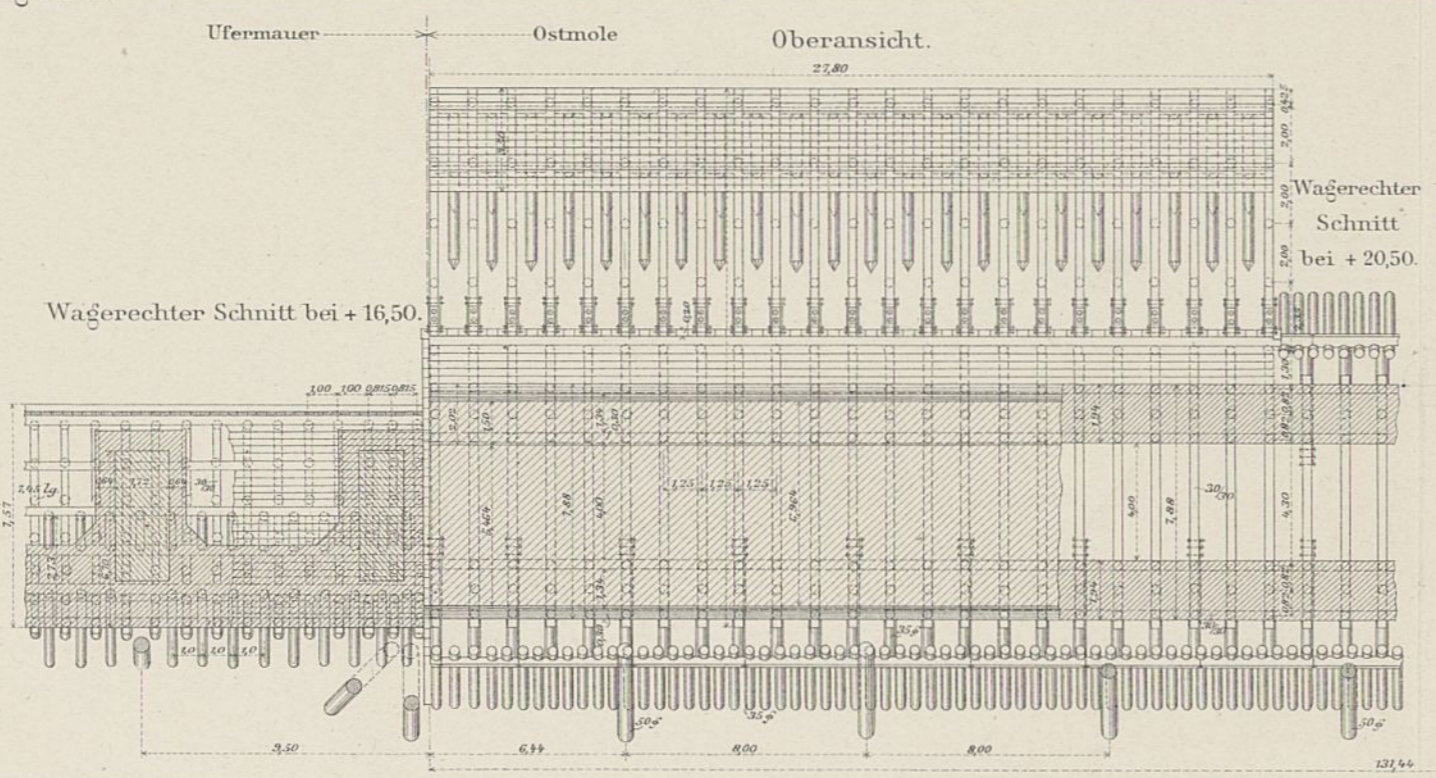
Grundriss u. Oberansicht der Ostmole und des anschliessenden Theils der Ufermauer am Vorhafen in Brunsbüttel. 1:250.
